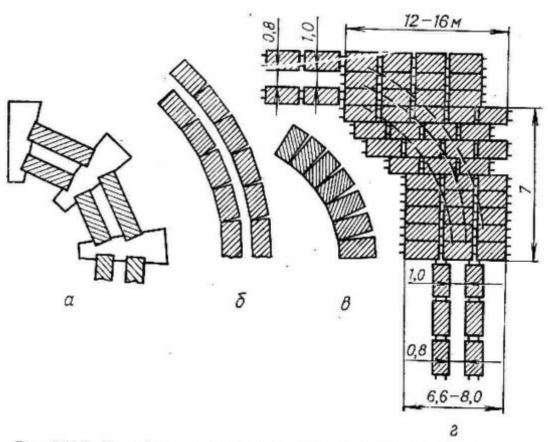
Способы укладки сборно-разборных покрытий на кривых: а — по специальным поперечивам трапецеидальной формы; 6 — на кривых большого радиуса; в — укладка щитов с зазором на кривых малого радвуса; в — укладка щитов вплотную на кривых малого радвуса
